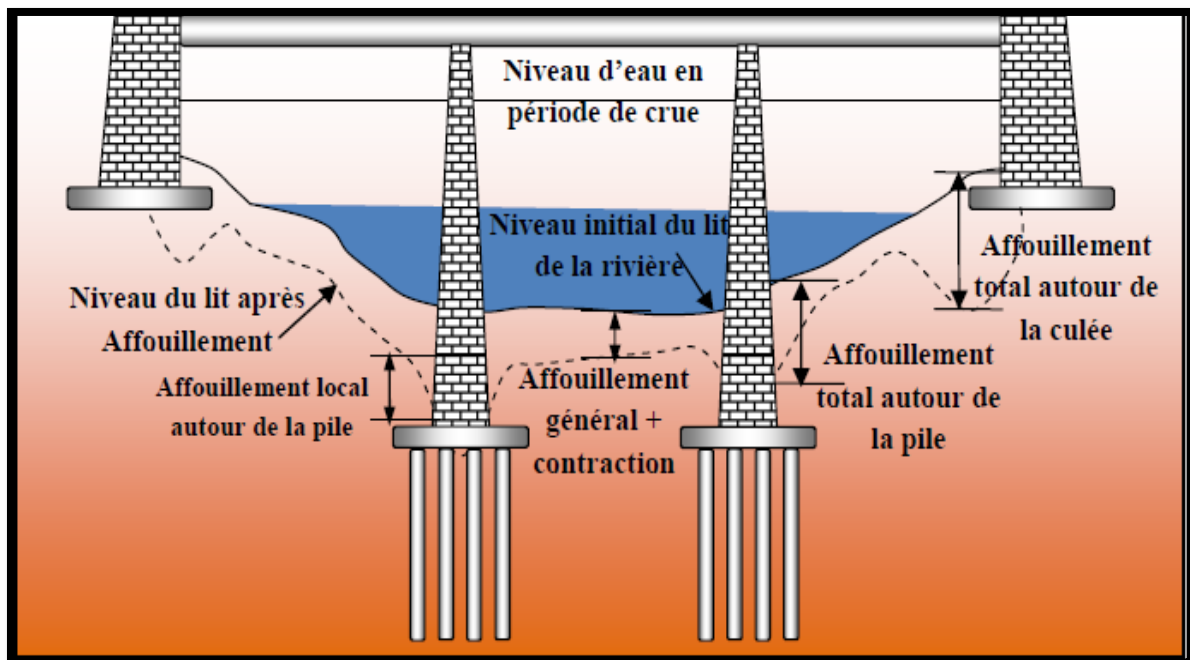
Affouillement total au droit d'une pile d'un pont (Melville et Coleman,2000)
